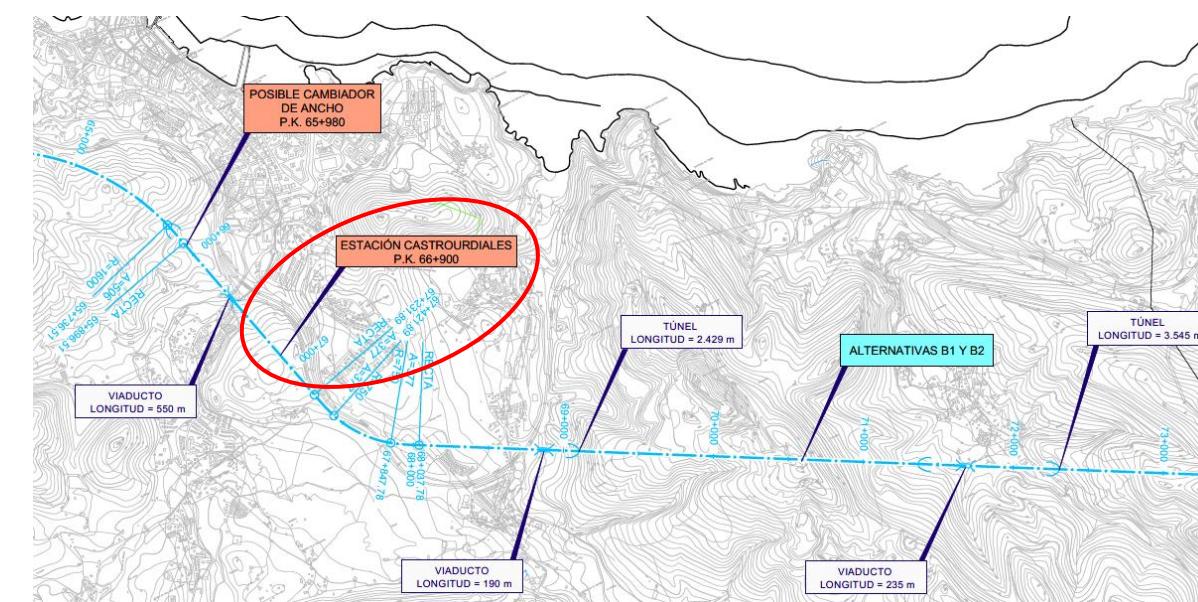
Estación Castro Urdiales en planta de Alternativa B1 y B2
